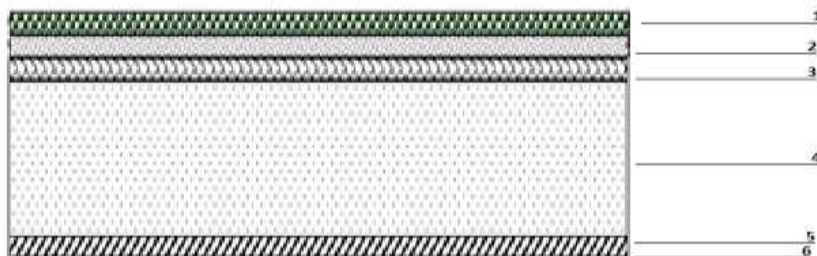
Coupe verticale du plancher courant à dalle pleine.
